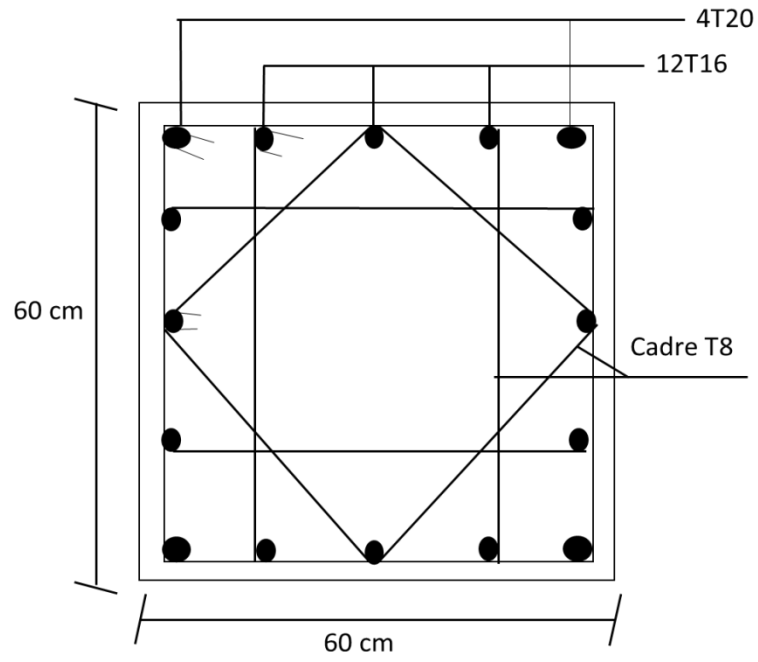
schéma du ferrailage Poteau 4^{eme} et 3^{eme} étage.
